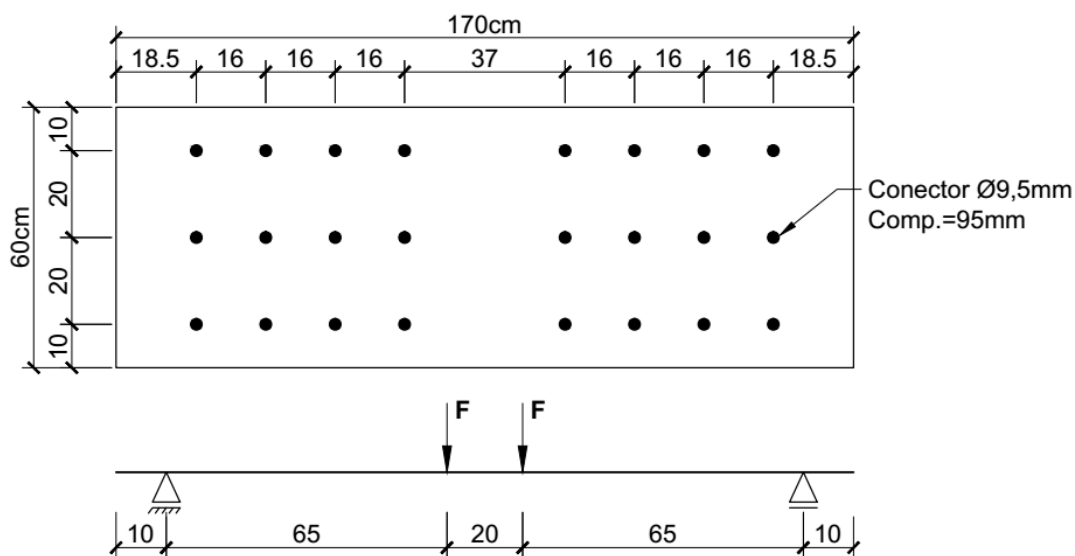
Planta baixa com a distribuição dos conectores de cisalhamento (laje da série 3) e esquema estático com as linhas de carga e apoios de todas as lajes.
